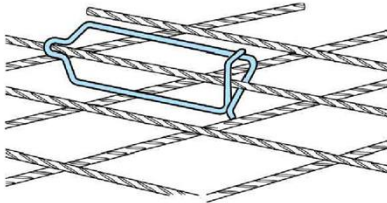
Einhängen wie dargestellt unter den oberen Bewehrungsstab.
